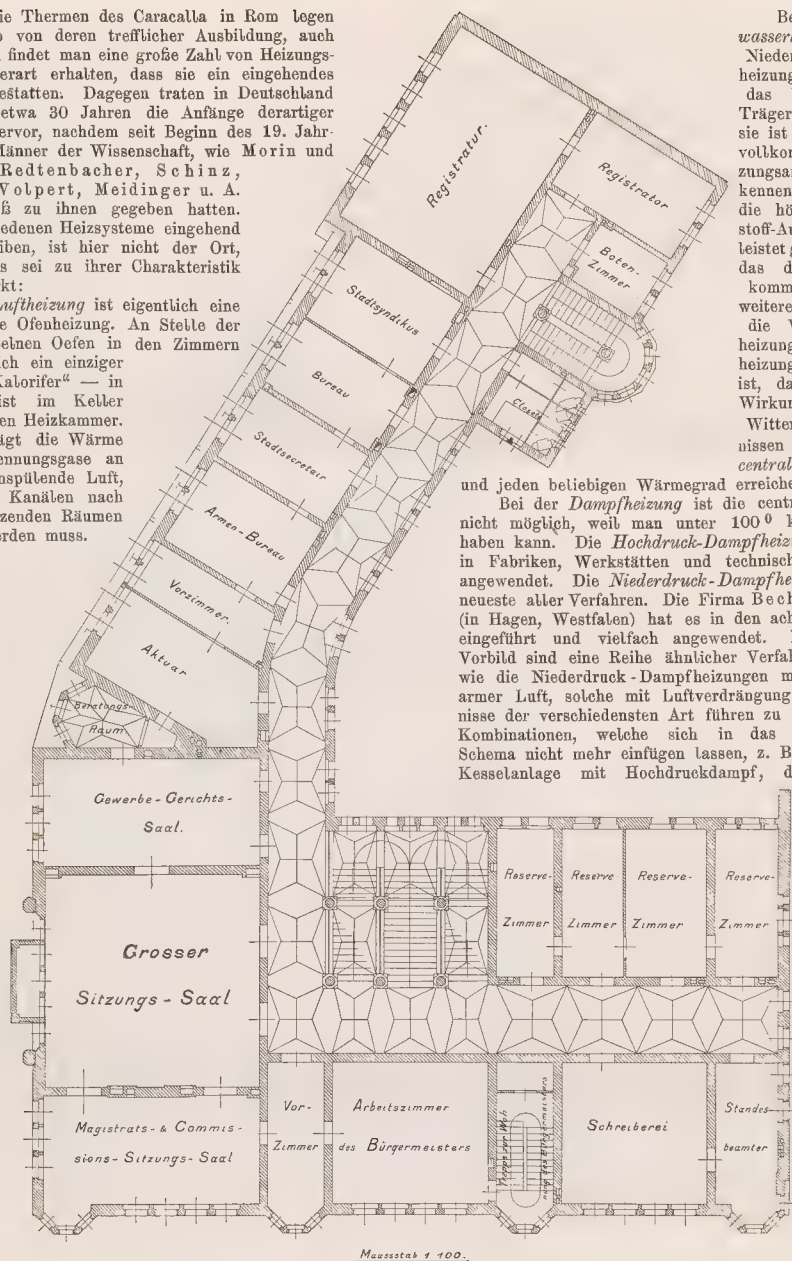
Rathhaus der Stadt Linden. (Grundriss des Erdgeschosses.)
